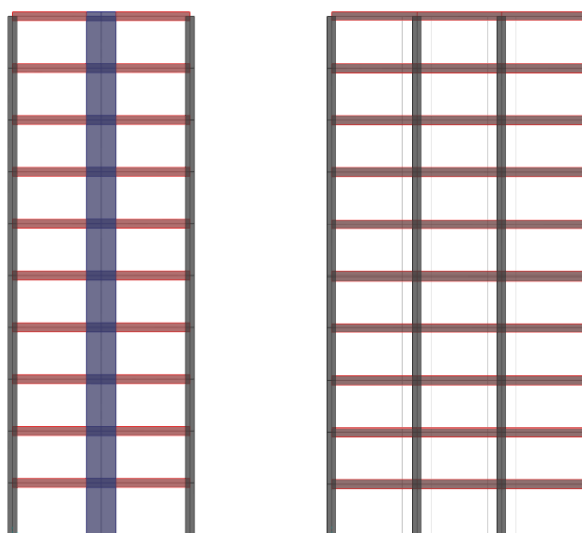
Vista lateral da estrutura mista (Pórtico/Parede)
